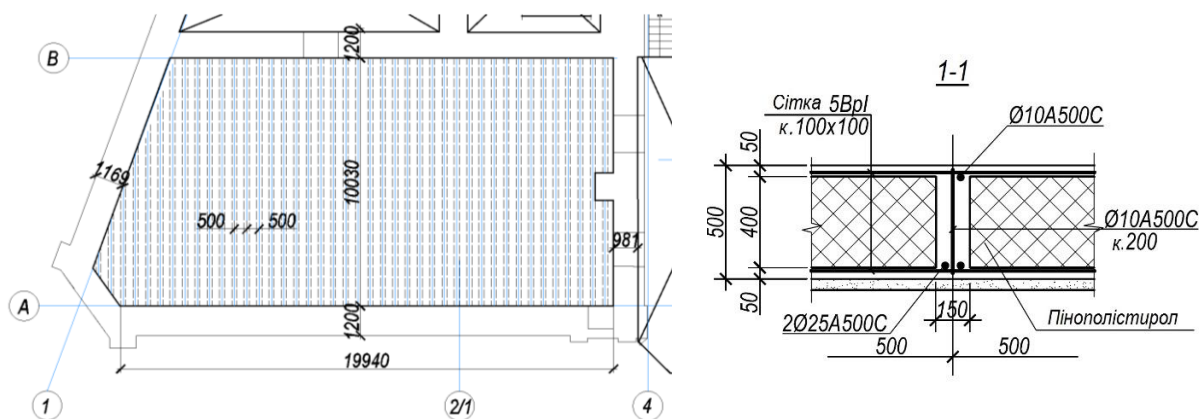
Конструктивна схема фрагменту залізобетонної плити перекриття ПМ-1:
